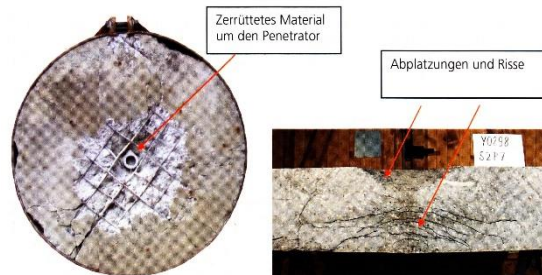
Links: Beschuss eines bewehrten Betonkörpers mit steckendem Penetrator (Vorderseite), rechts: mittig durchgesägte Betonplatte nach Beanspruchung durch eine Kontaktladung (Explosionseinwirkung) [14]
